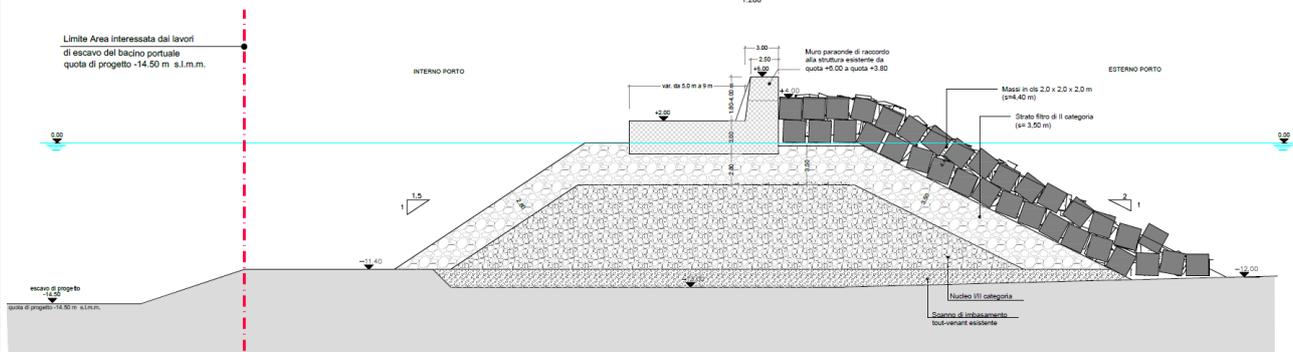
Progetto Esecutivo: Prolungamento Molo Soprattutto – sezione G-G
